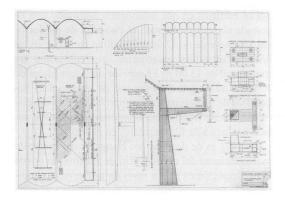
Plano de detalles constructivos y estructurales de la estación de autobuses en Salto (Archivo Dieste)
